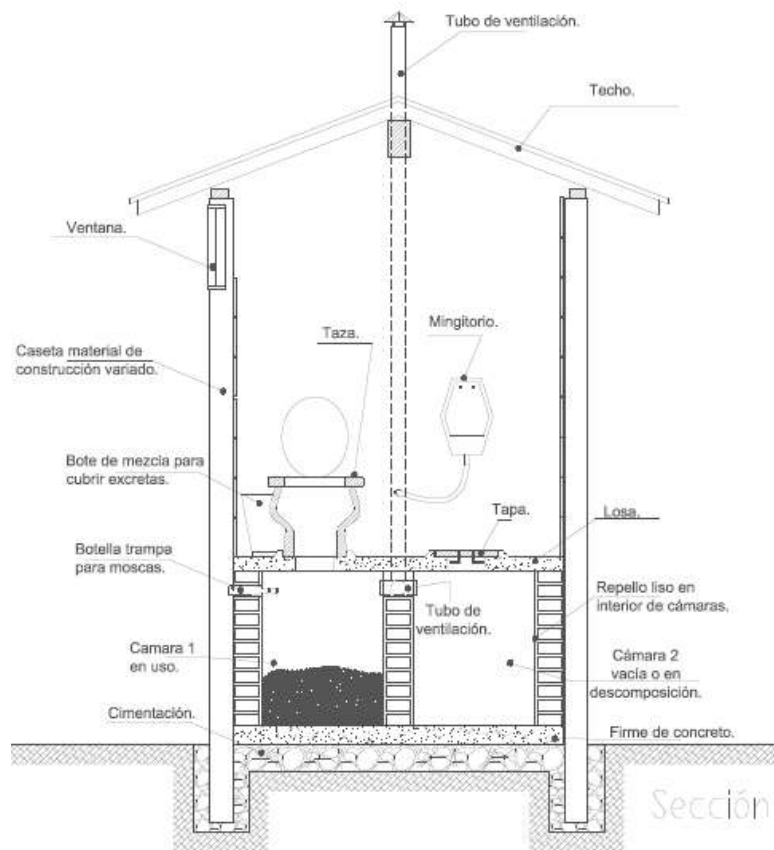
Sección Elementos Constructivos para la Letrina Seca. Elaboración del autor.
